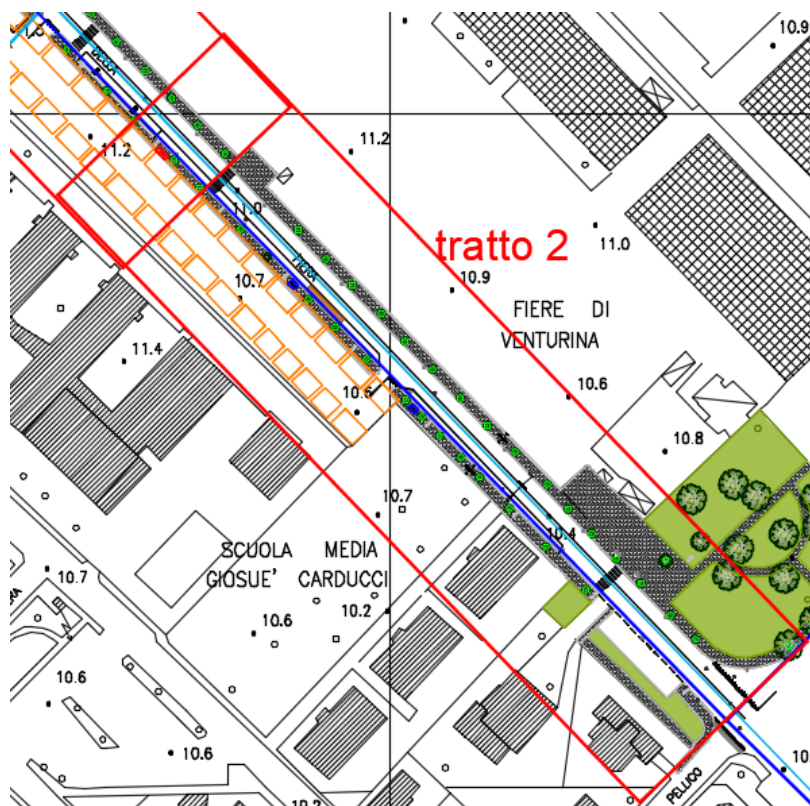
Planimetria dello Stato di fatto tratto 2 con i sottoservizi
